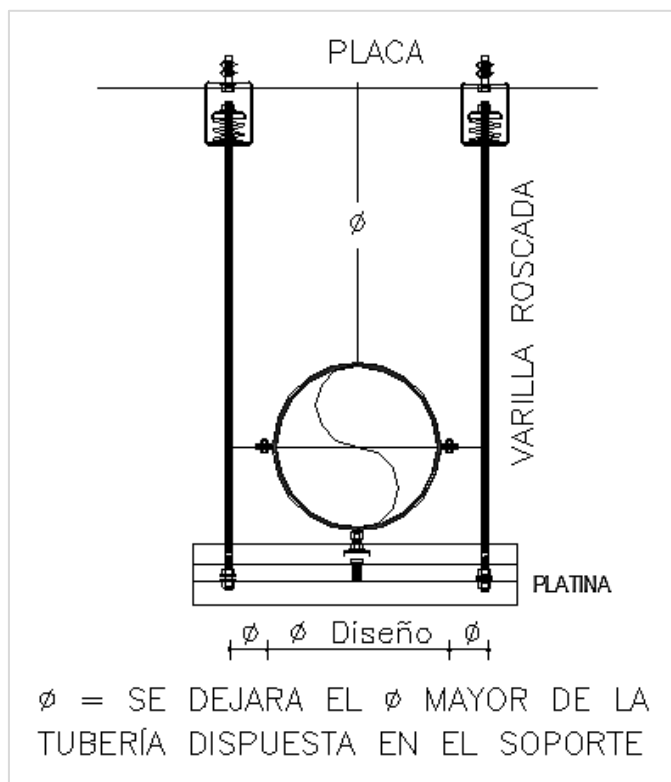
Disposición tubería bajo placa a la vista. Elaboración propia
